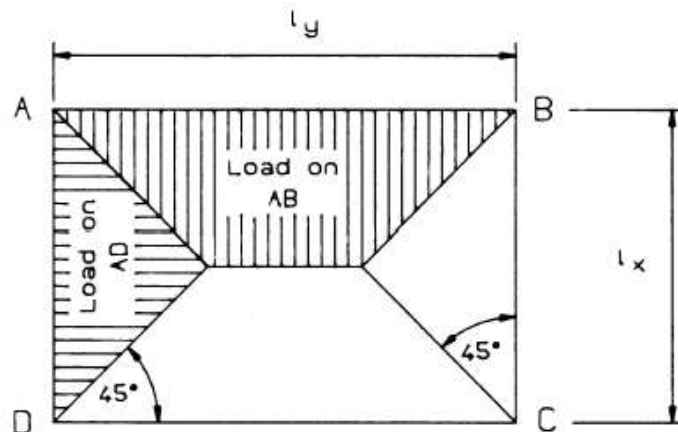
Distribución de carga en losas bidireccionales rectangulares.
